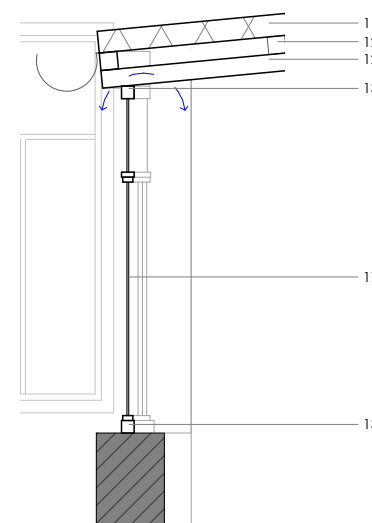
Detalle Constructivo 07. Esc. 1:50
